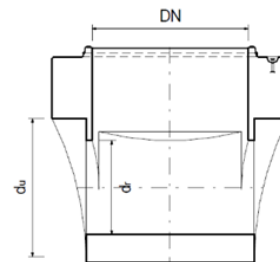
Aussparungen für nachträglichen Anschluss mit Bodenöffnung
